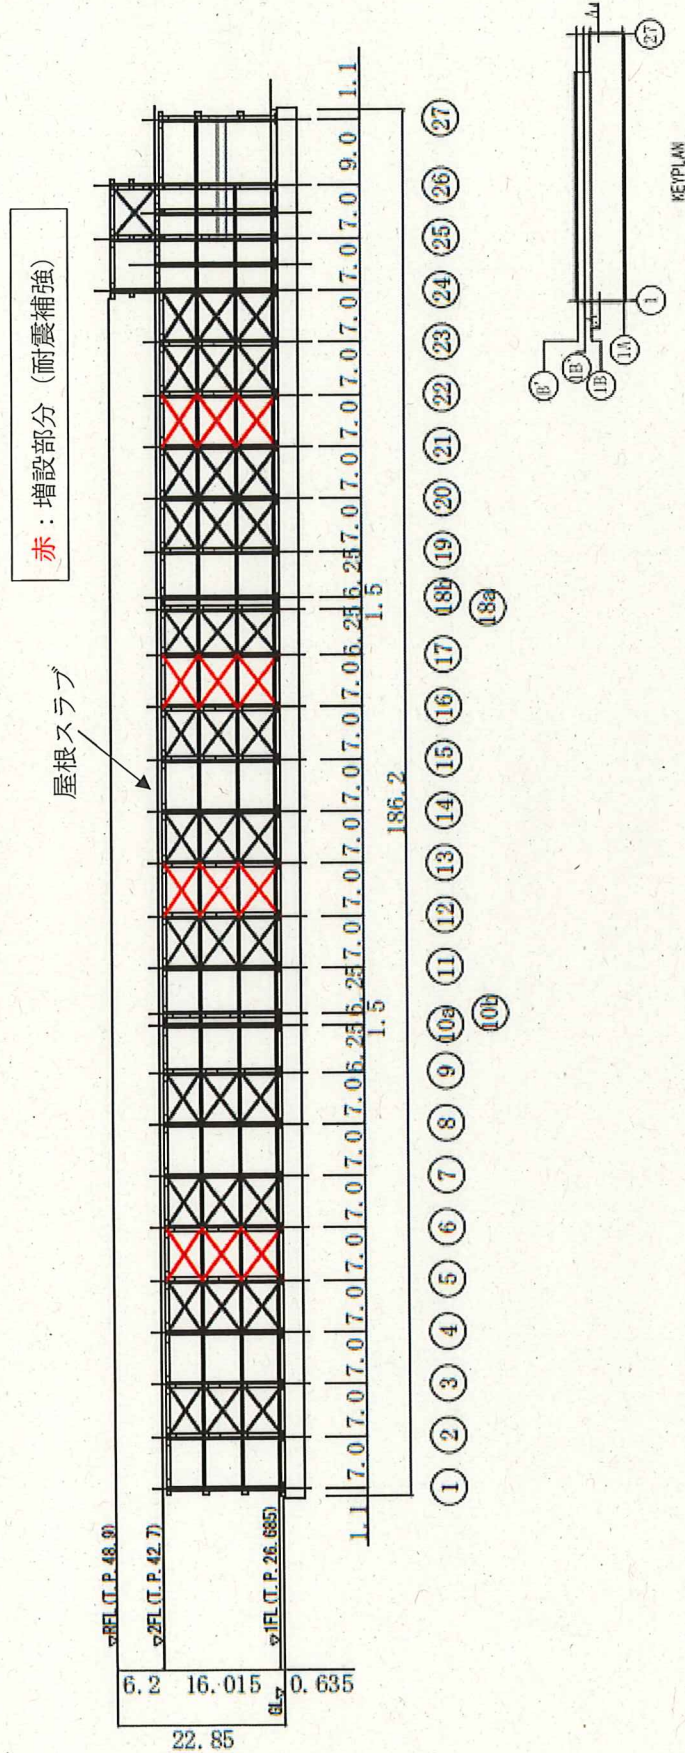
(5) A-A 断面図 (NS 方向) (単位 : m)
